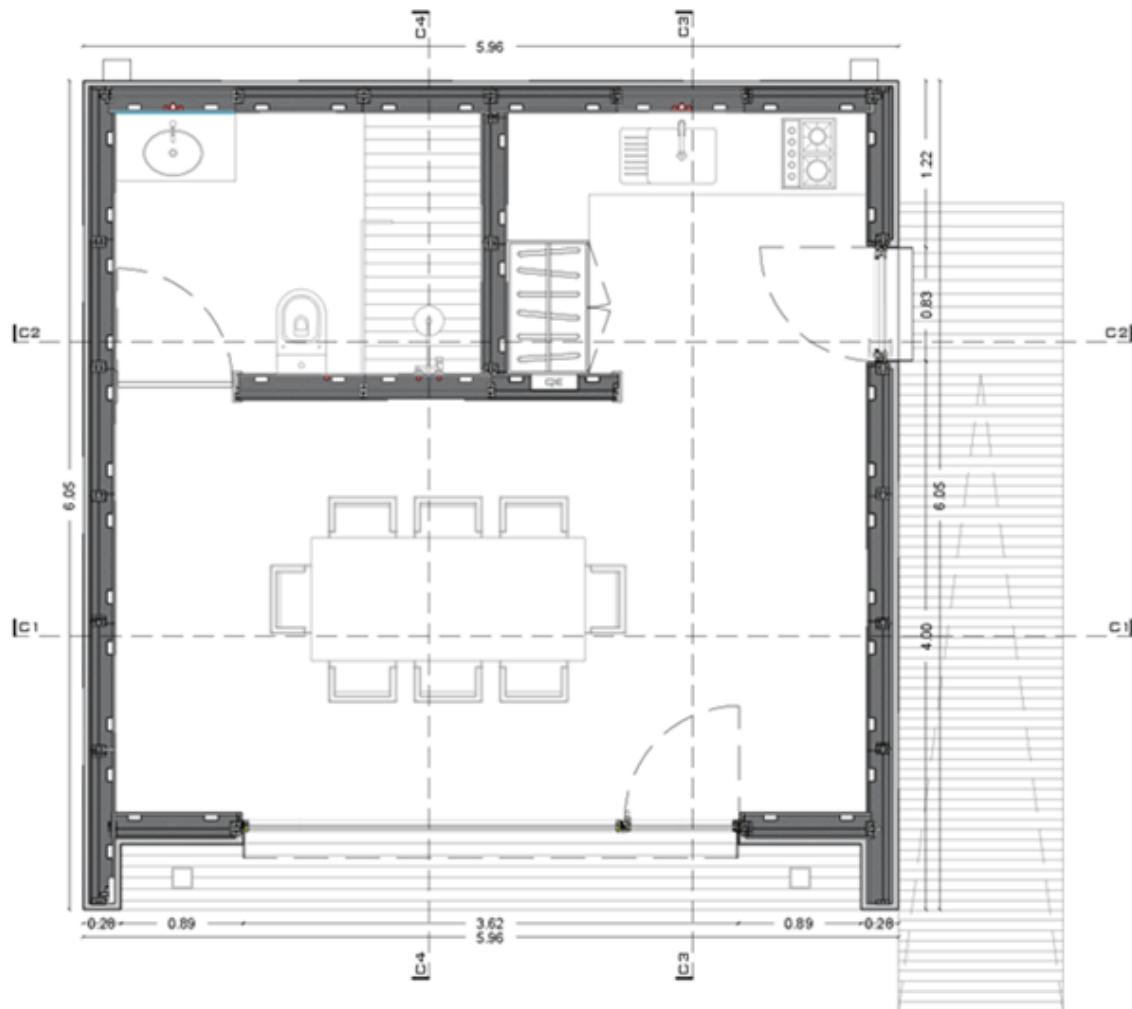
Planta Piso 0 - Integração da Solução Construtiva CircularBuild
